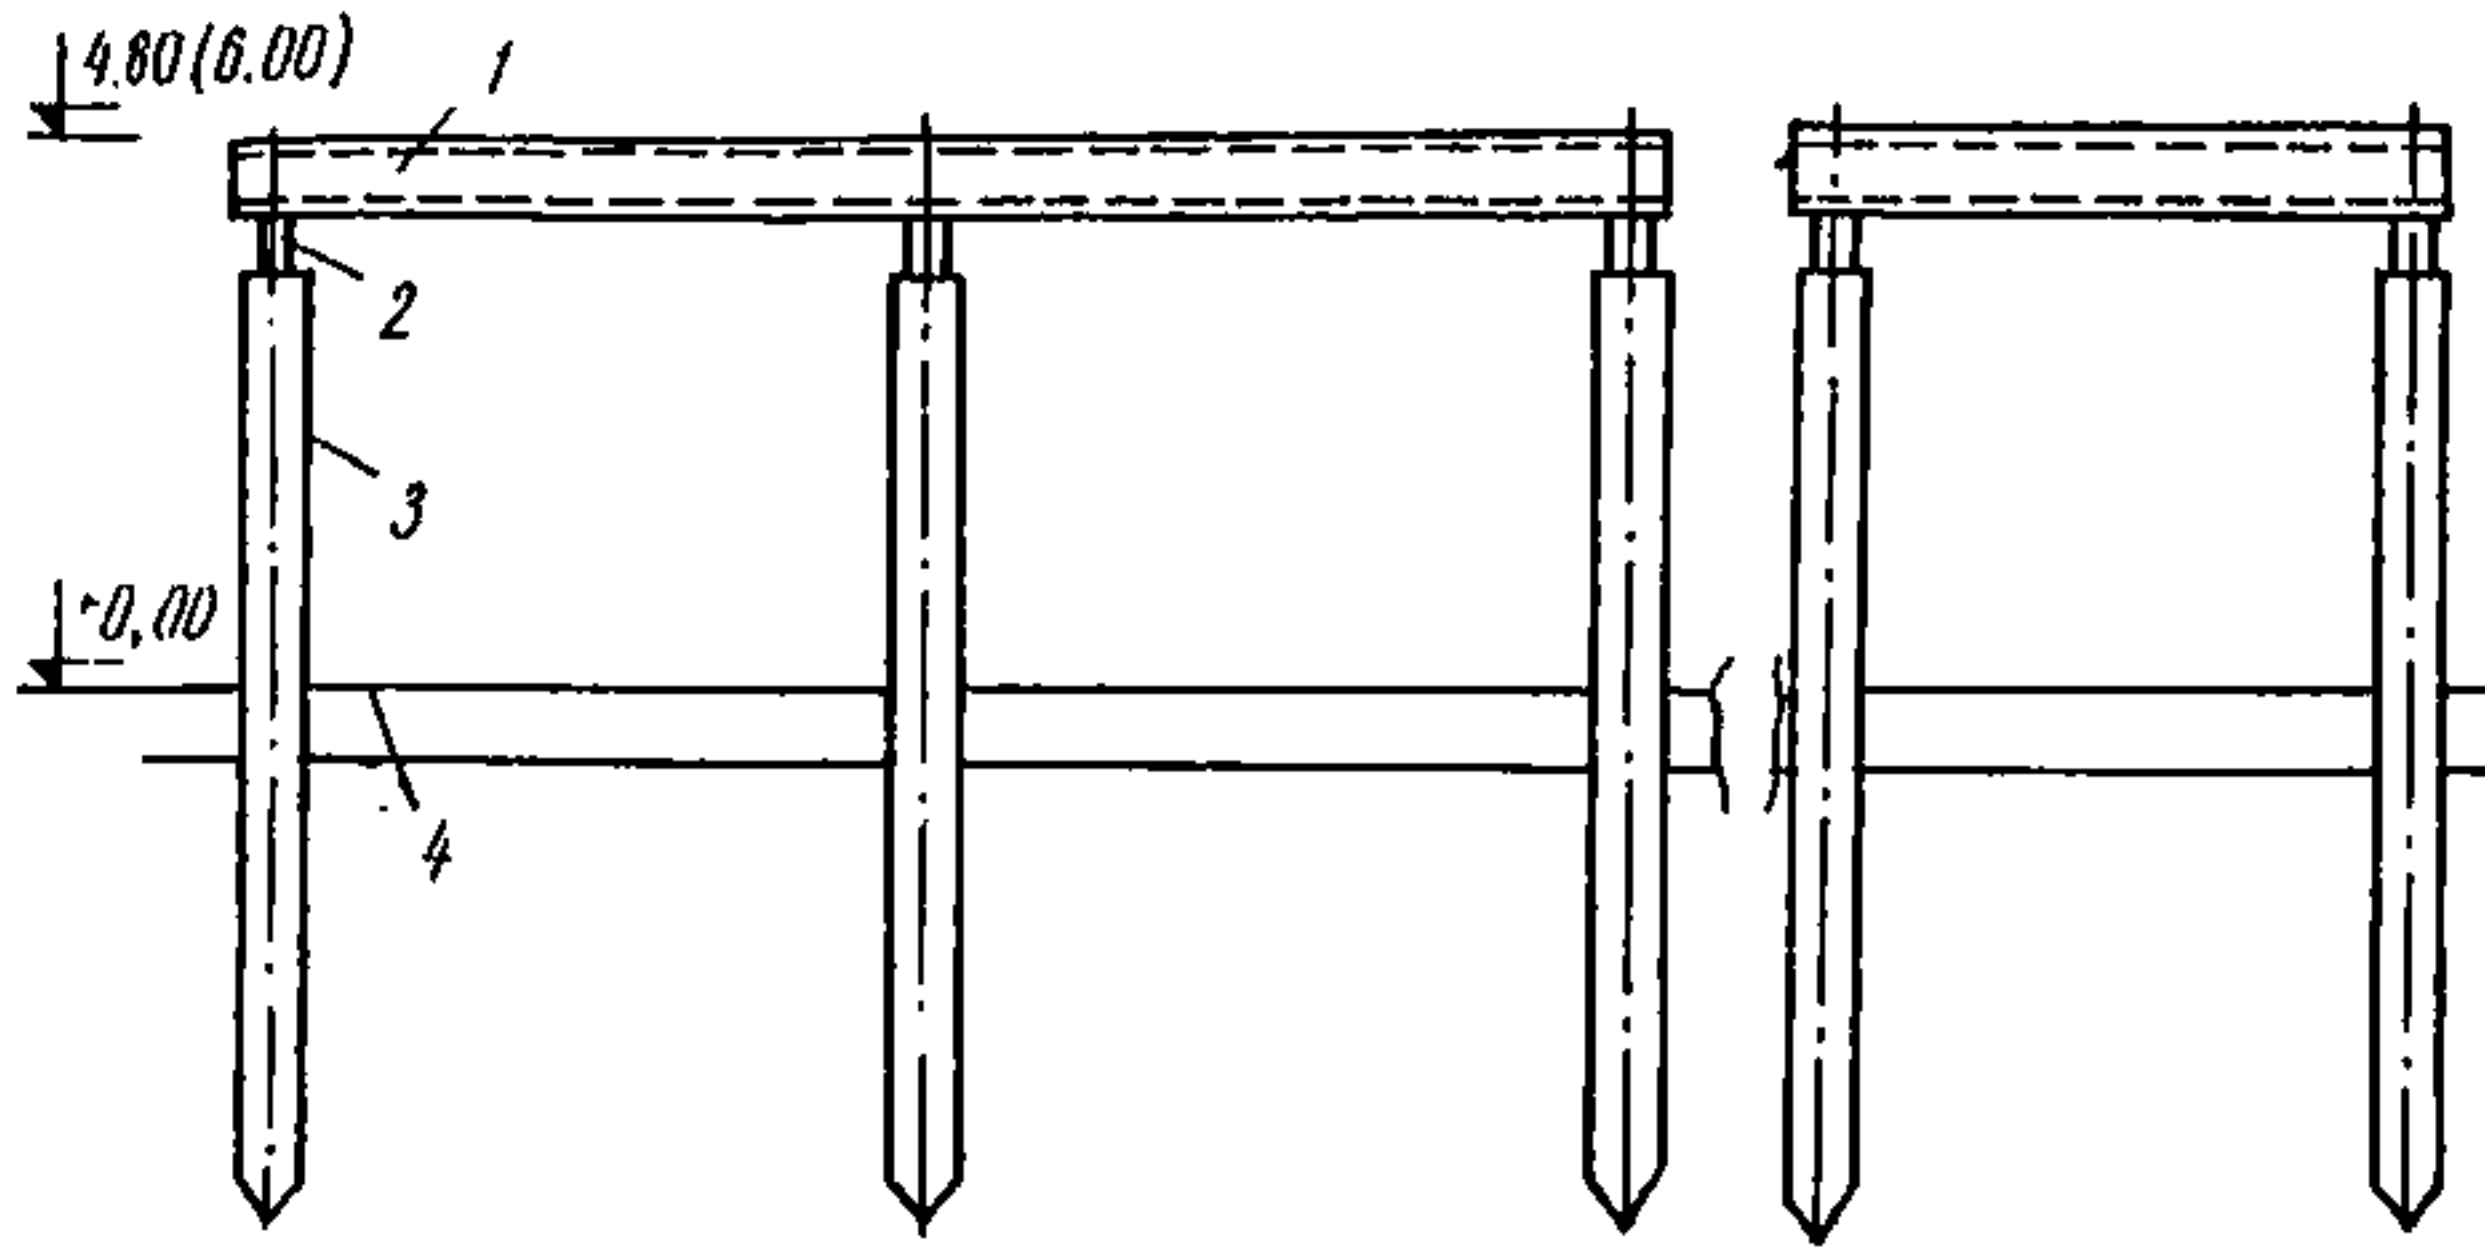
Схема рамного фундамента с использованием железобетонных свай-оболочек
